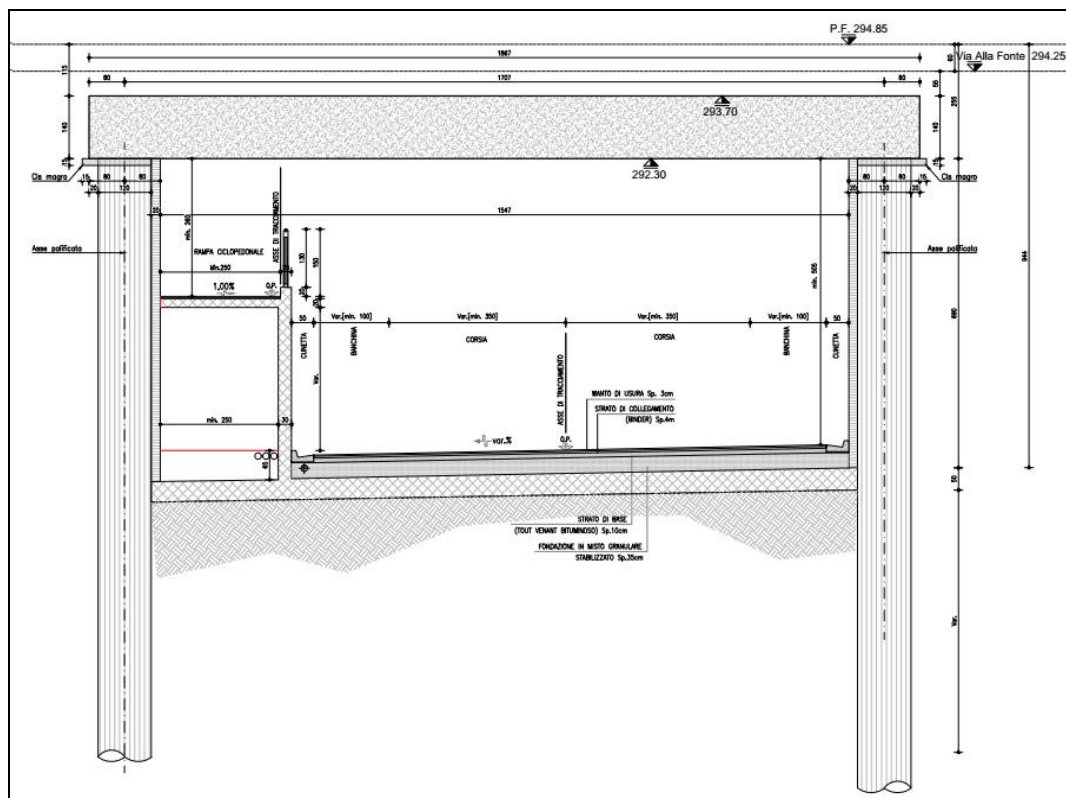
Sezione tipo asse principale con pista ciclopedonale e palificata con soletta
